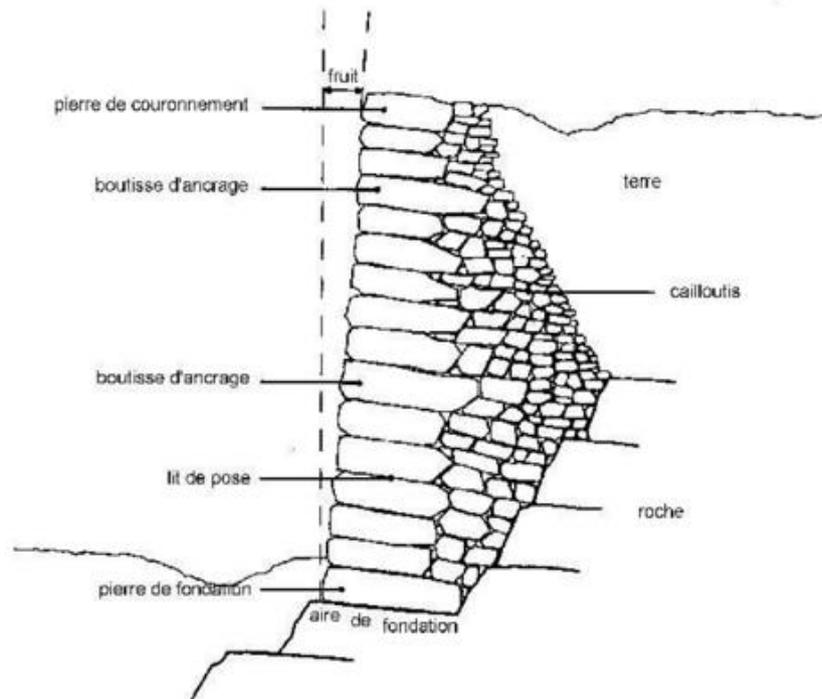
Coupe d'un mur de soutènement. Crédit : Christian Lassure, CERAV
